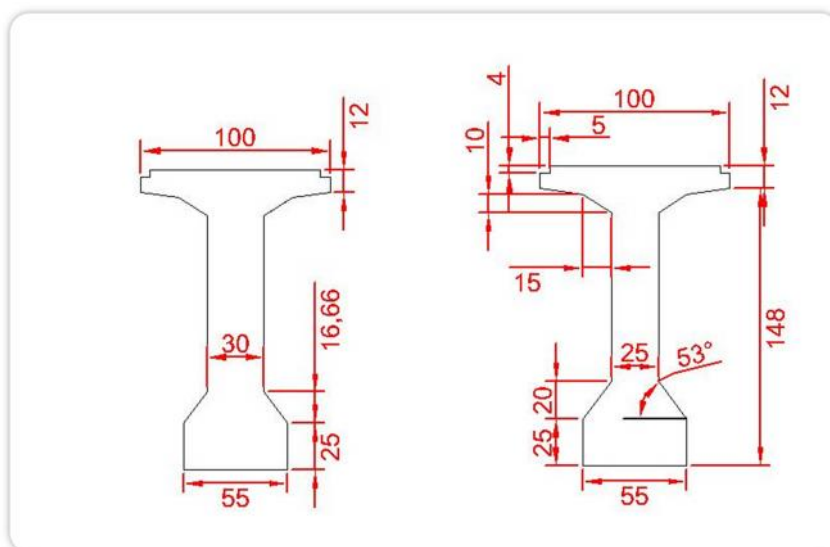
Dimensions de la section des poutres sur appui (à gauche) et en travée (à droite)
